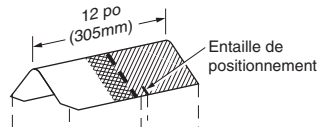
Les bardeaux accessoires Shadow Ridge se détachent facilement de la bande de trois pièces pour former 72 pièces de recouvrement individuelles.
